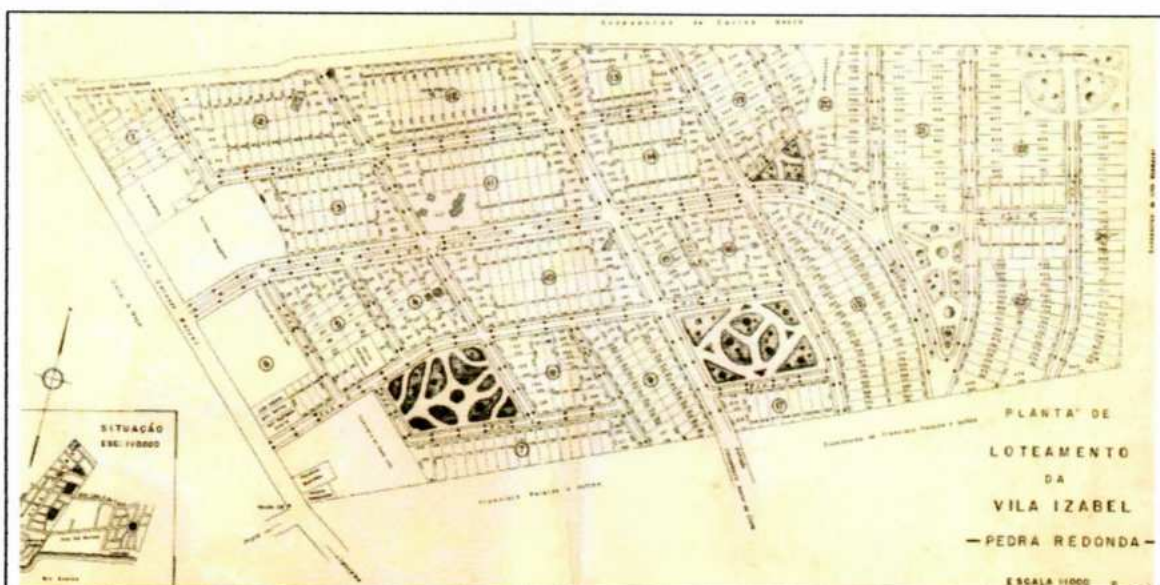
Vila Izabel, hoje Jardim Isabel, foi o desdobramento em lotes da chácara da família Dreher, projeto de loteamento aprovado em 1954. Se estende da Av. Coronel Marcos subindo a encosta.
